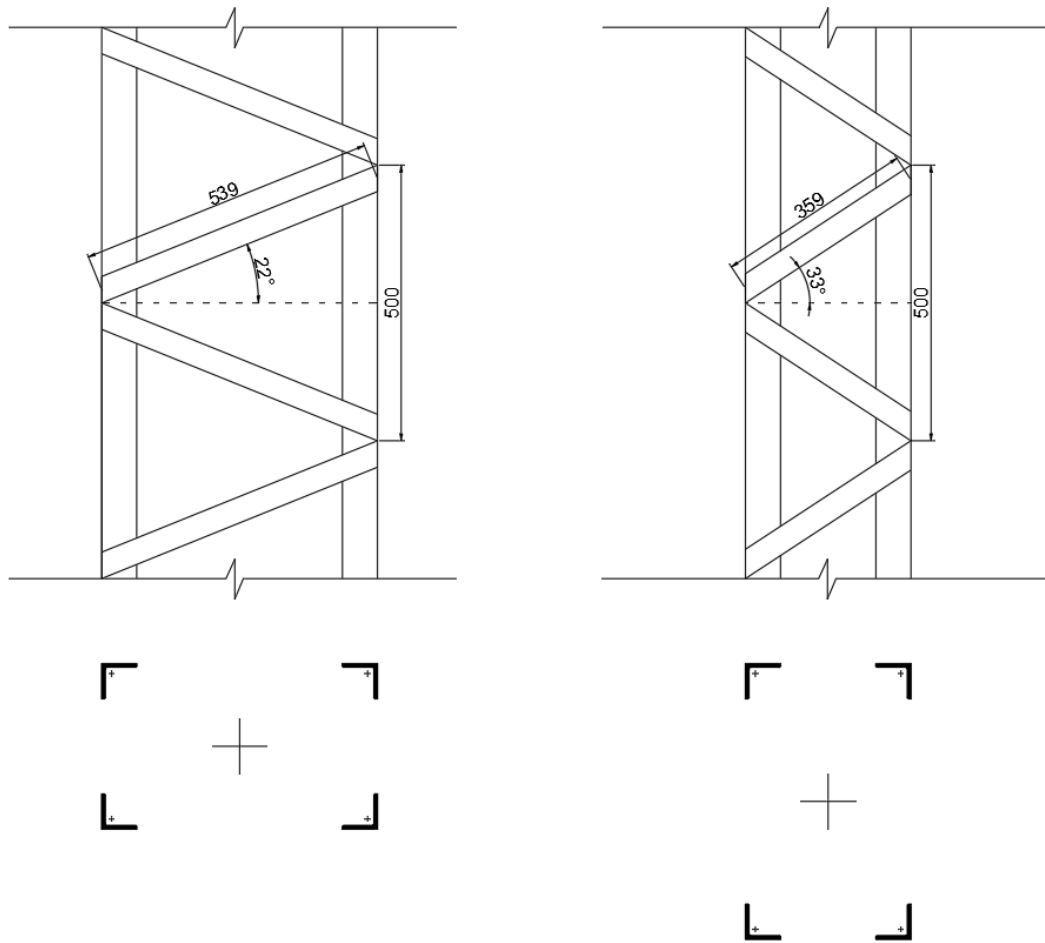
Detalle de la sección adoptada para la columna metálica
